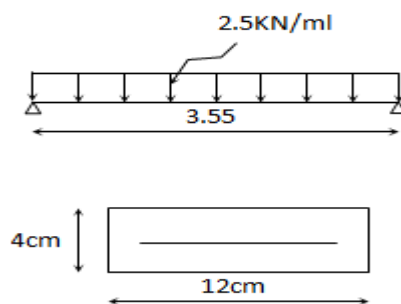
Schéma statique de la poutrelle et son chargement avant coulage de la dalle de compression.
